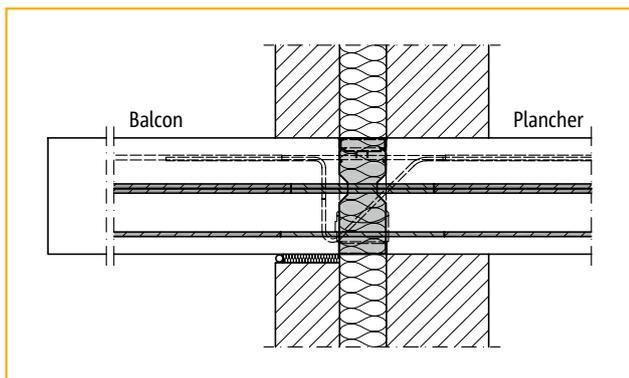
Façade en mur ceux + isolation avec balcon en prolongement de dalle + modèle K + module EQ
